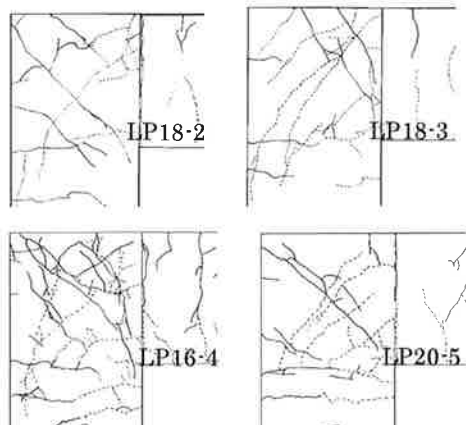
終局時ひび割れ図 ($R=\pm 1/50$)
